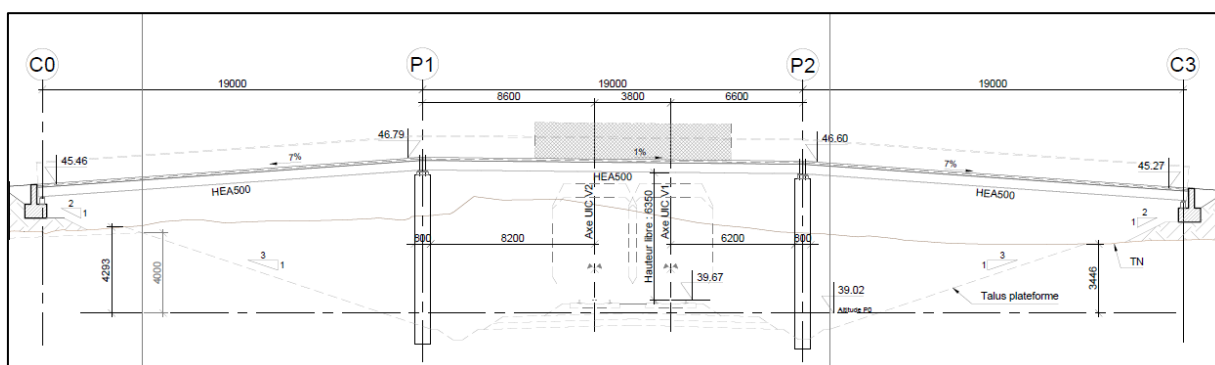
Coupe projet de la PAS SEBIKHOTANE sur plateforme à 2 voies UIC
